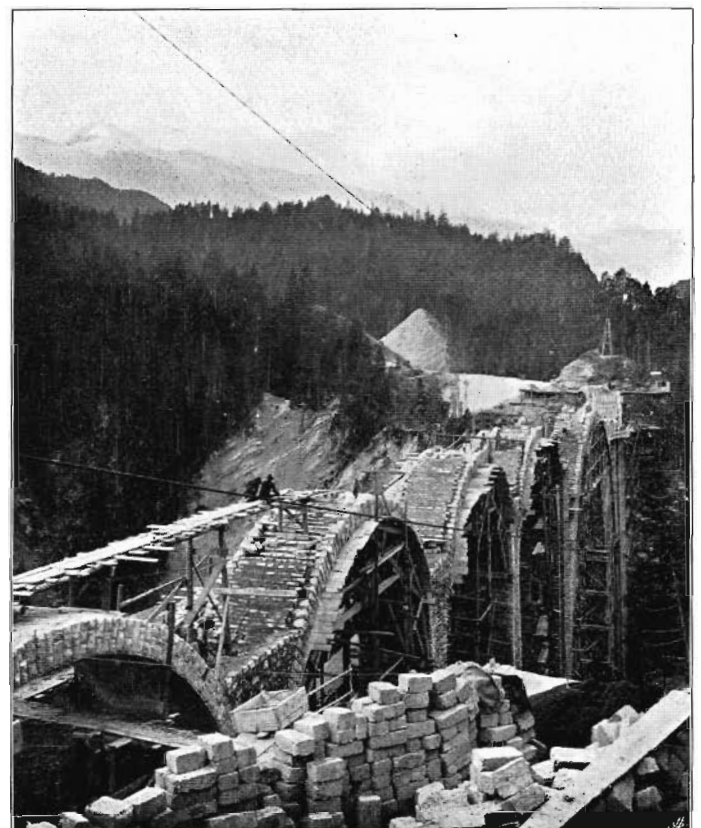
Mauerung der rechtsufrigen Seitenöffnungen am Wiesener Viadukt mit Beton-Formsteinen.
